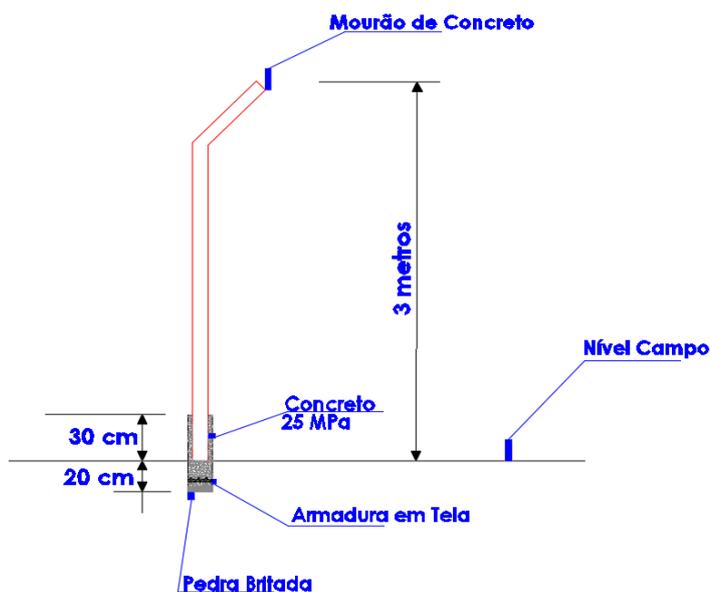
Corte do alambrado detalhando a fundação, com a viga e o mourão.
